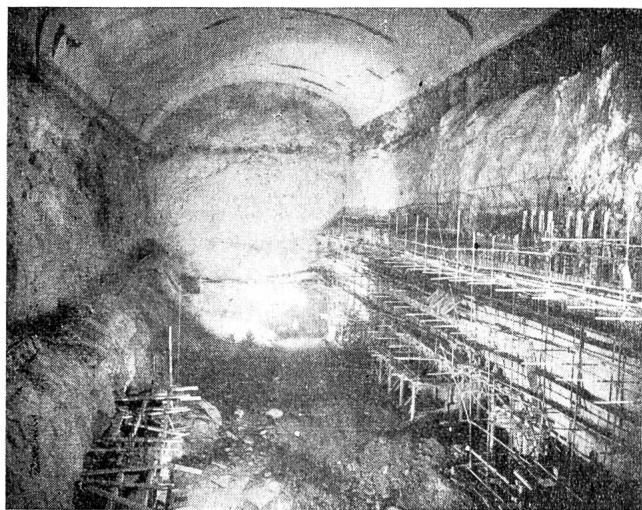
Lavey. L'usine souterraine. — Le 15 mai 1948. L'excavation en voie d'achèvement. La paroi intérieure amont en cours de bétonnage. Vue de l'entrée.
